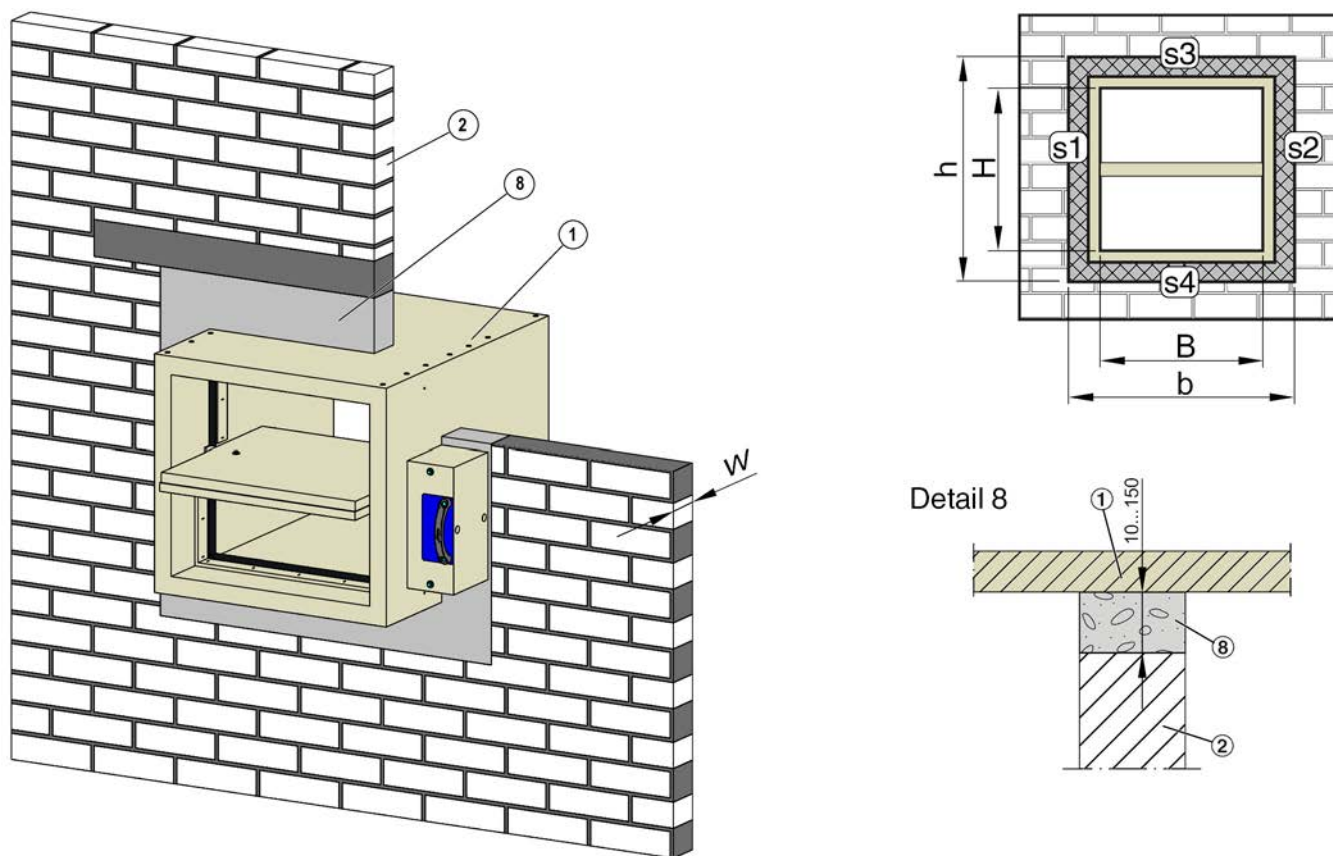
Installazione a secco senza muratura in muro solido, variante di installazione a, indice di classificazione:  $v_{ew}$
